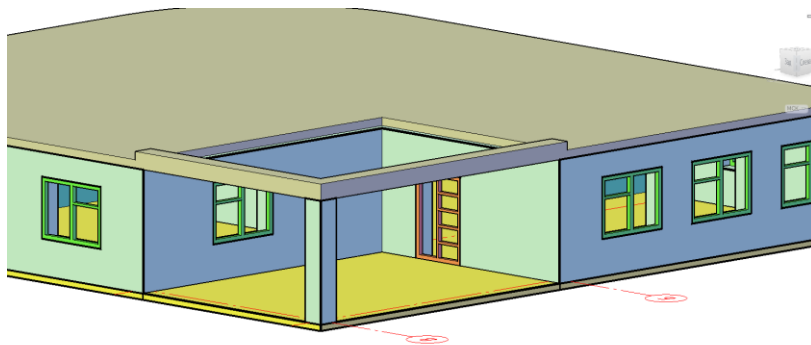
Фрагмент котеджа із змодельованими плитами по ґрунту/перекриття
